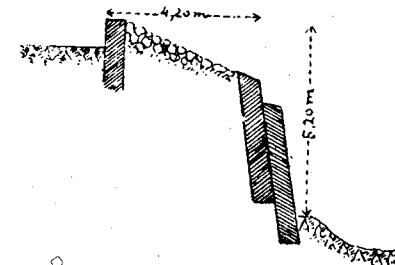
CORTE TRANSVERSAL DA MURALHA DE SABROSO (LADO NASCENTE)
